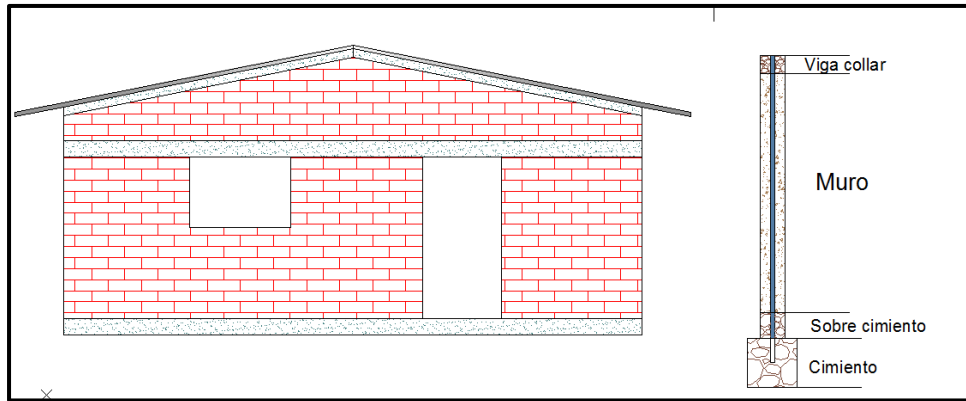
Fachada frontal de un prototipo de vivienda de adobe
